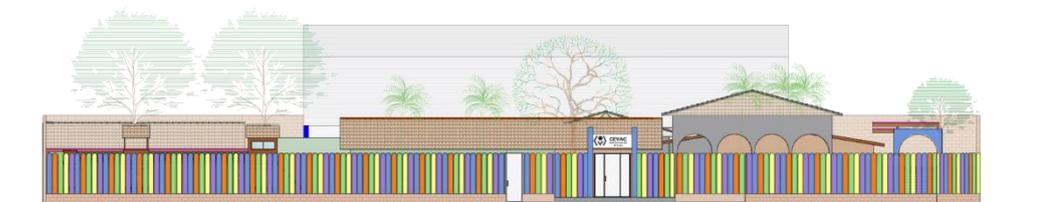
Elevação 1 – Fachada (Fonte: Produção do autor).
